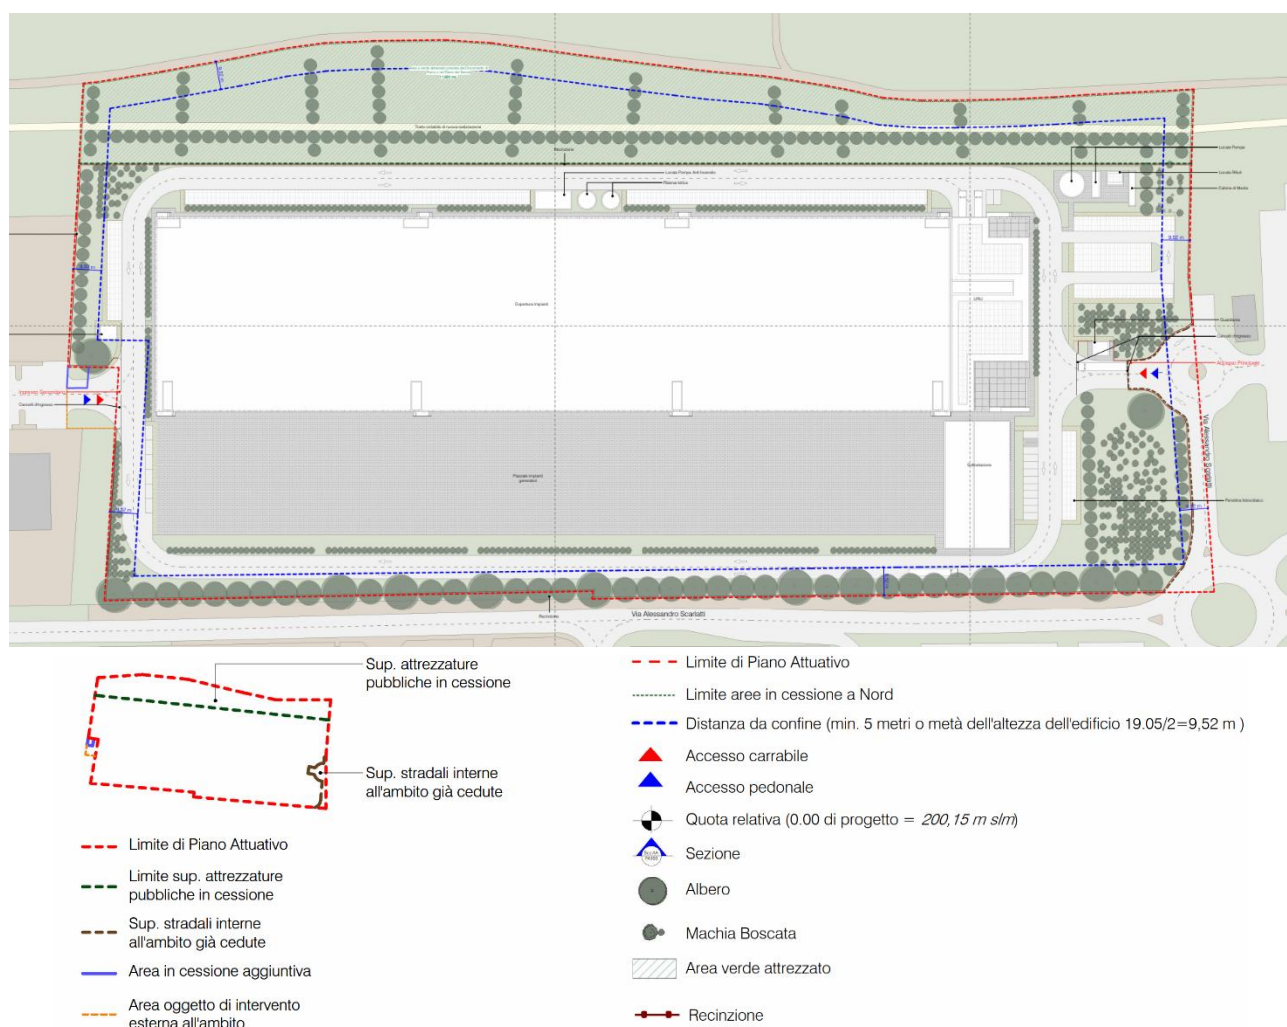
Planimetria Generale delle opere esterne (elaborato AC-0016)
